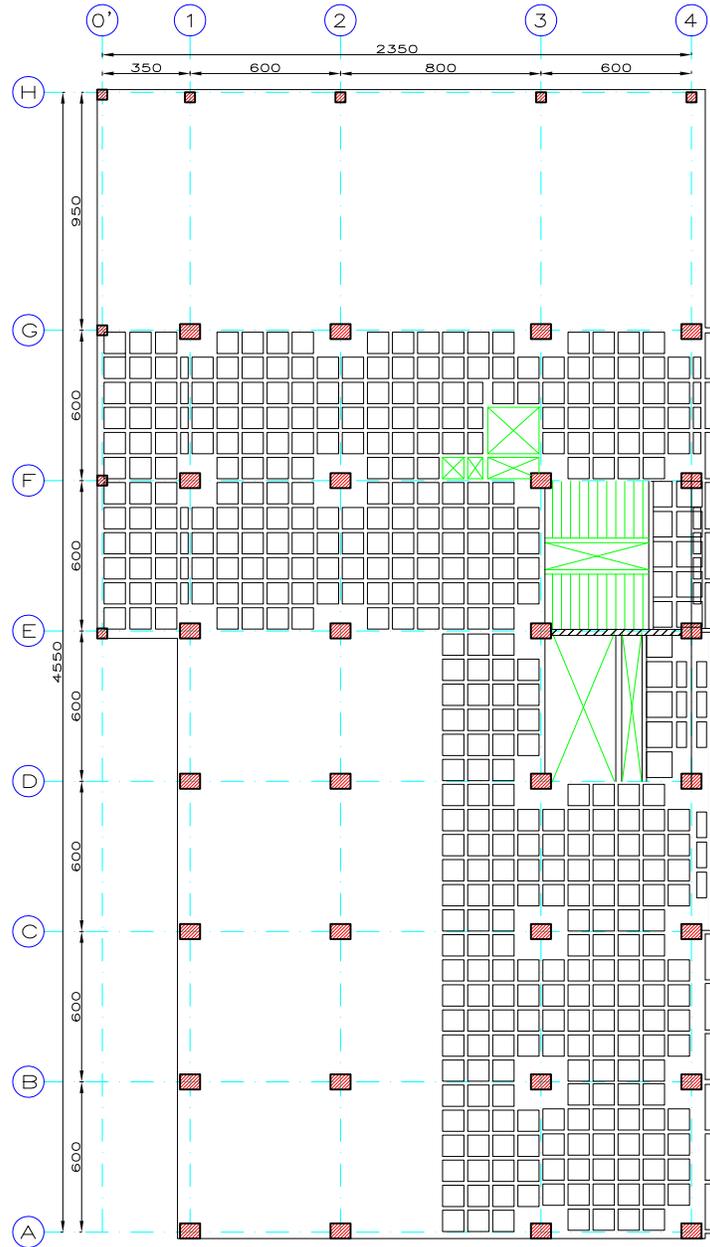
PLANTA NIVEL MEZZANINE (NTC +4.800)
